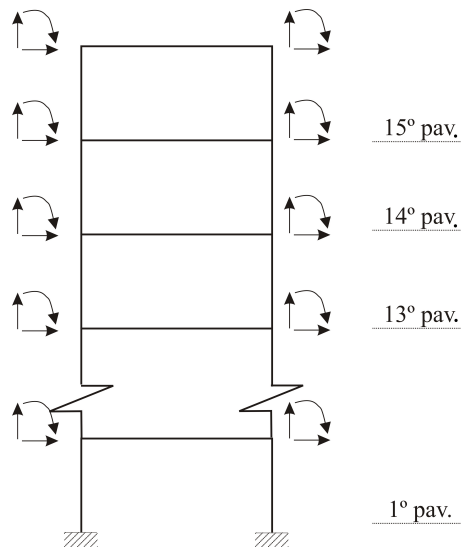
Ilustração do pórtico plano discretizado em elementos finitos com 32 nós.
